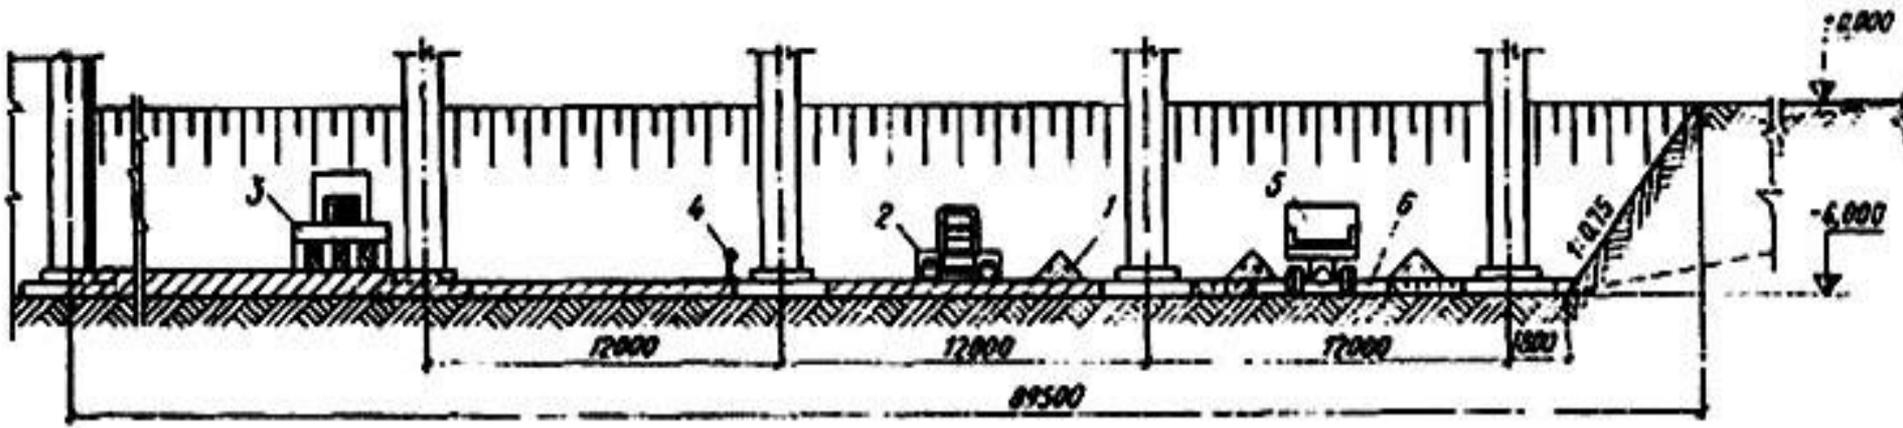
Схема обратной засыпки связным грунтом котлована с установленными колоннами:
